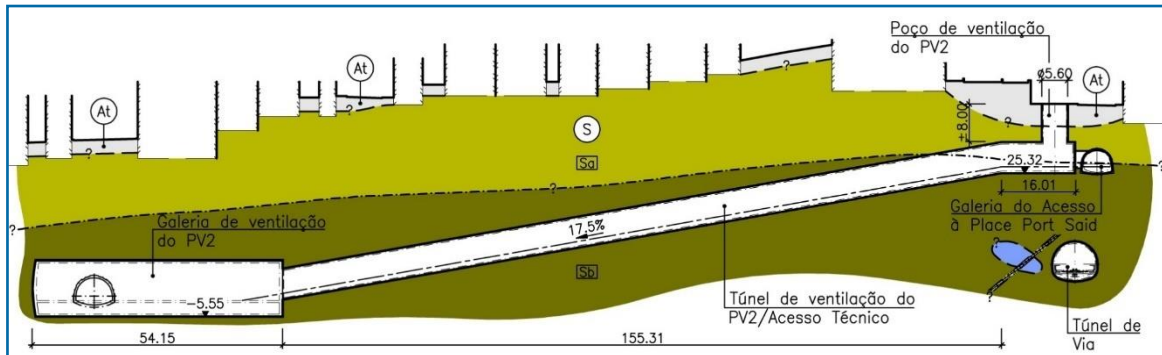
Perfil longitudinal das obras associadas ao PV2
